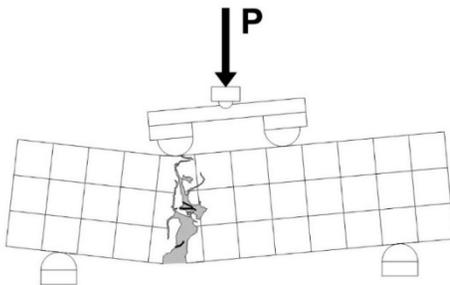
Non Linear Cracked Phase pada Balok Beton BS02
